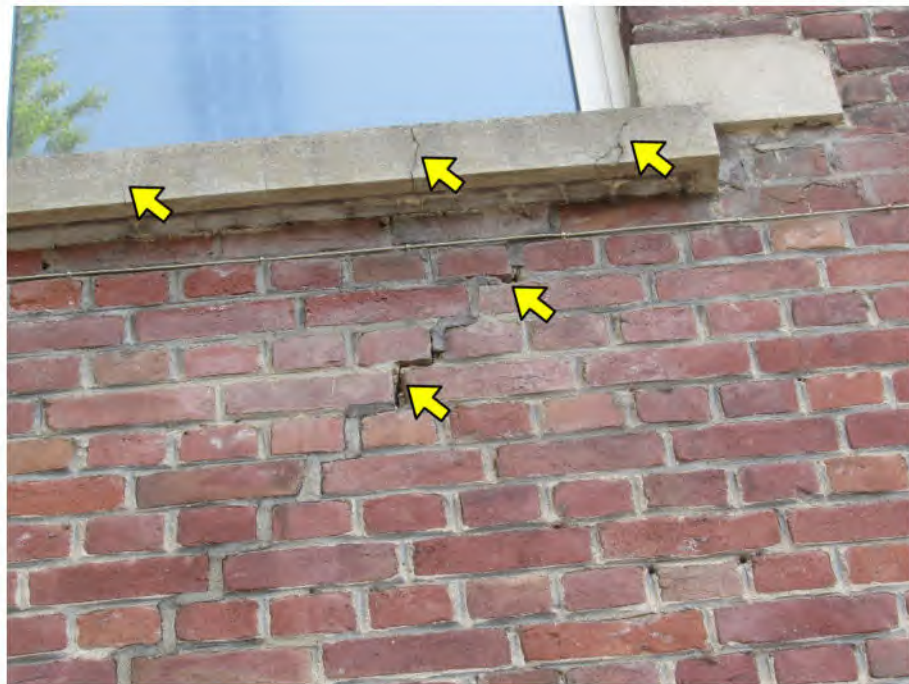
ehem. Klostergebäude: Risse in der Fassade und in den Außenfensterbänken
